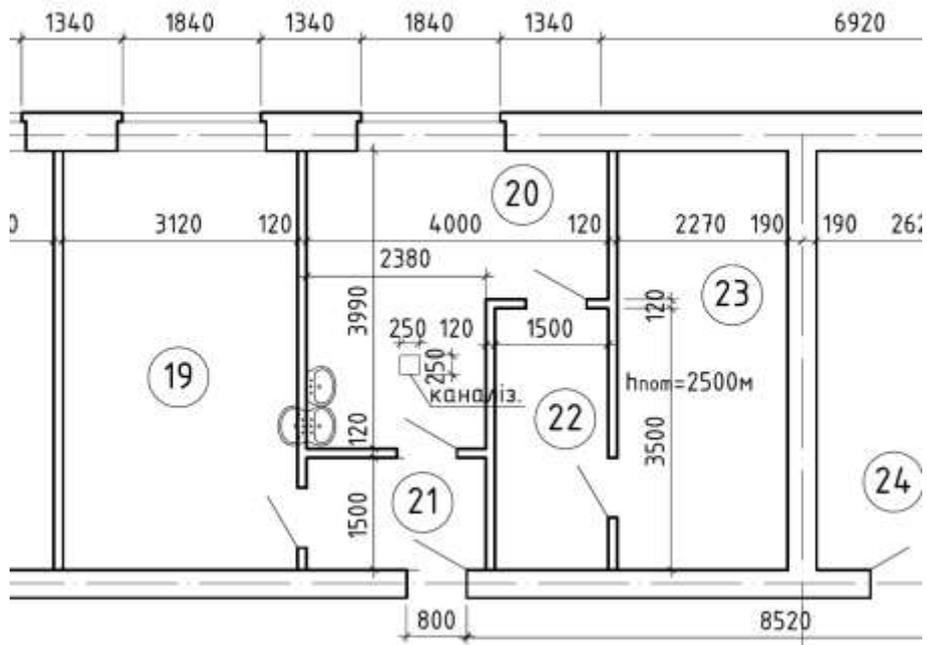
Приміщення цокольного поверху до реконструкції (19 – технічне приміщення; 20 – умивальник; 21 – коридор; 22 – роздягальня; 23 – душова, 24 – сходові клітина).
